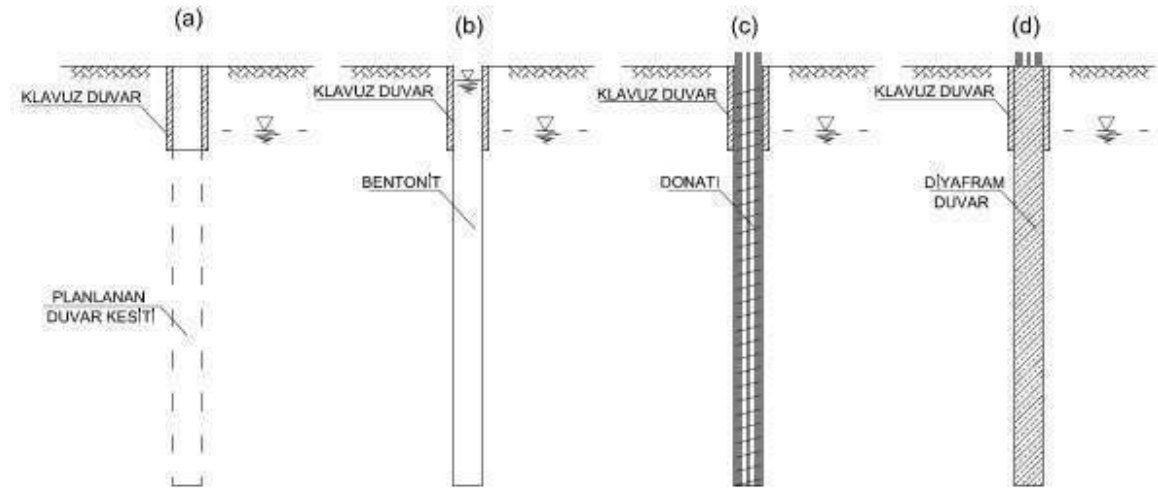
Kuyu tipi betonarme duvar tipik kesiti.
